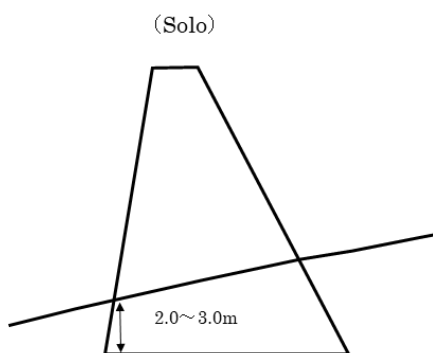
Ficha da barreira assente em solo (seção transversal à barreira)
